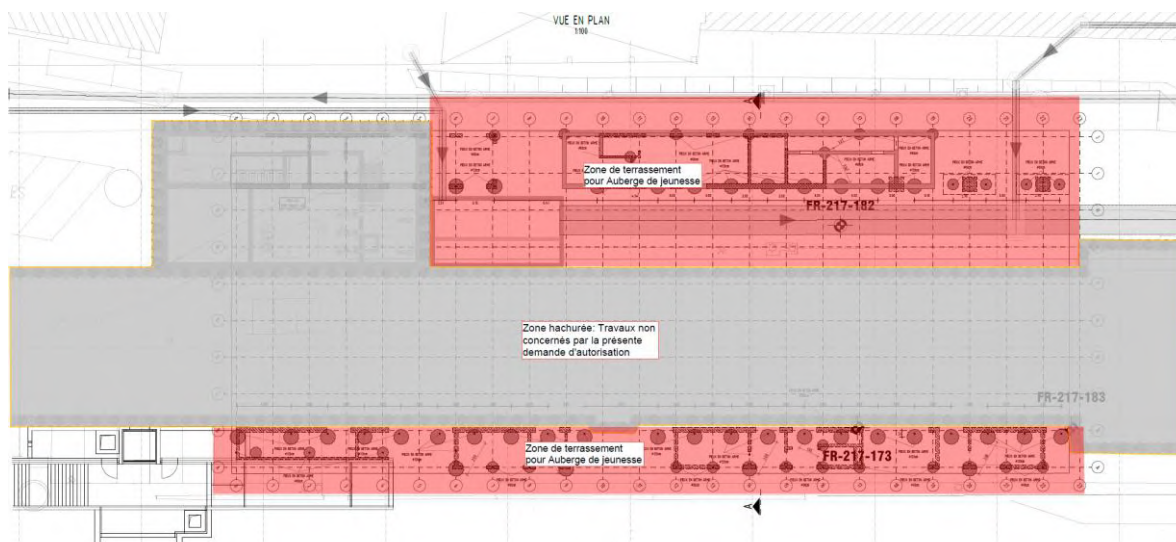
Vue en plan terrassement / fondations « bâtiment Auberge de jeunesse »
